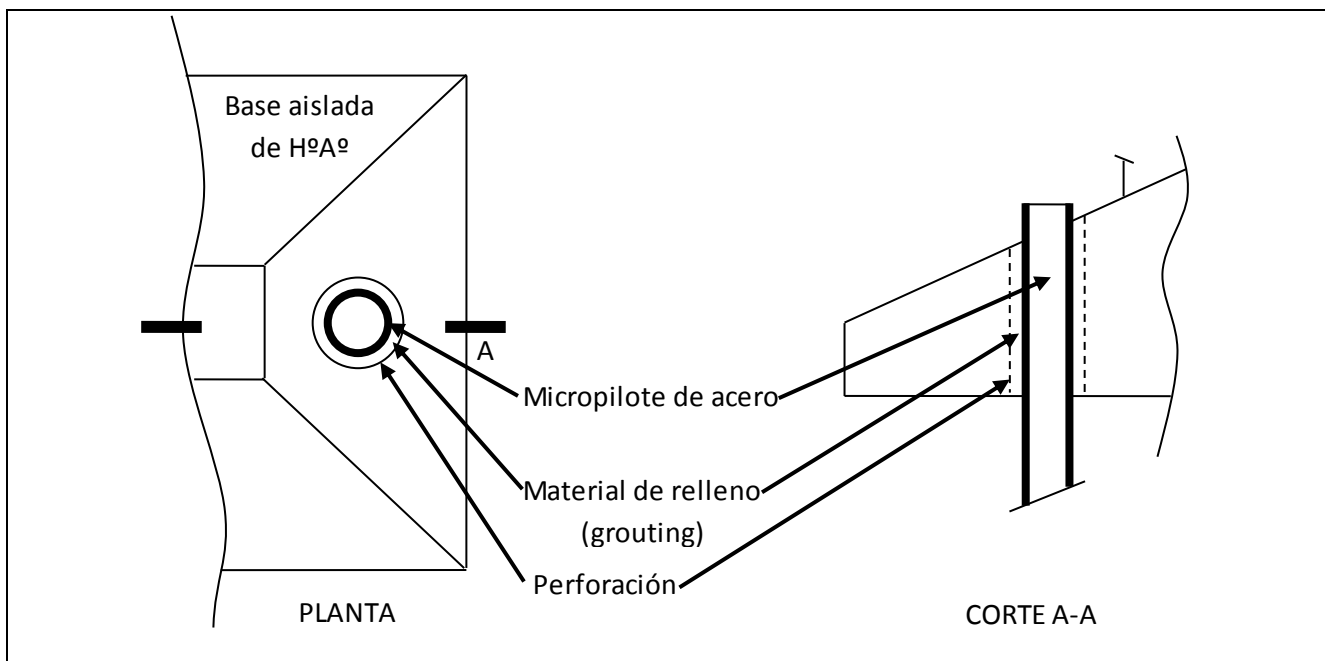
Planta y corte de la forma de vinculación entre el micropilote y la base aislada.
